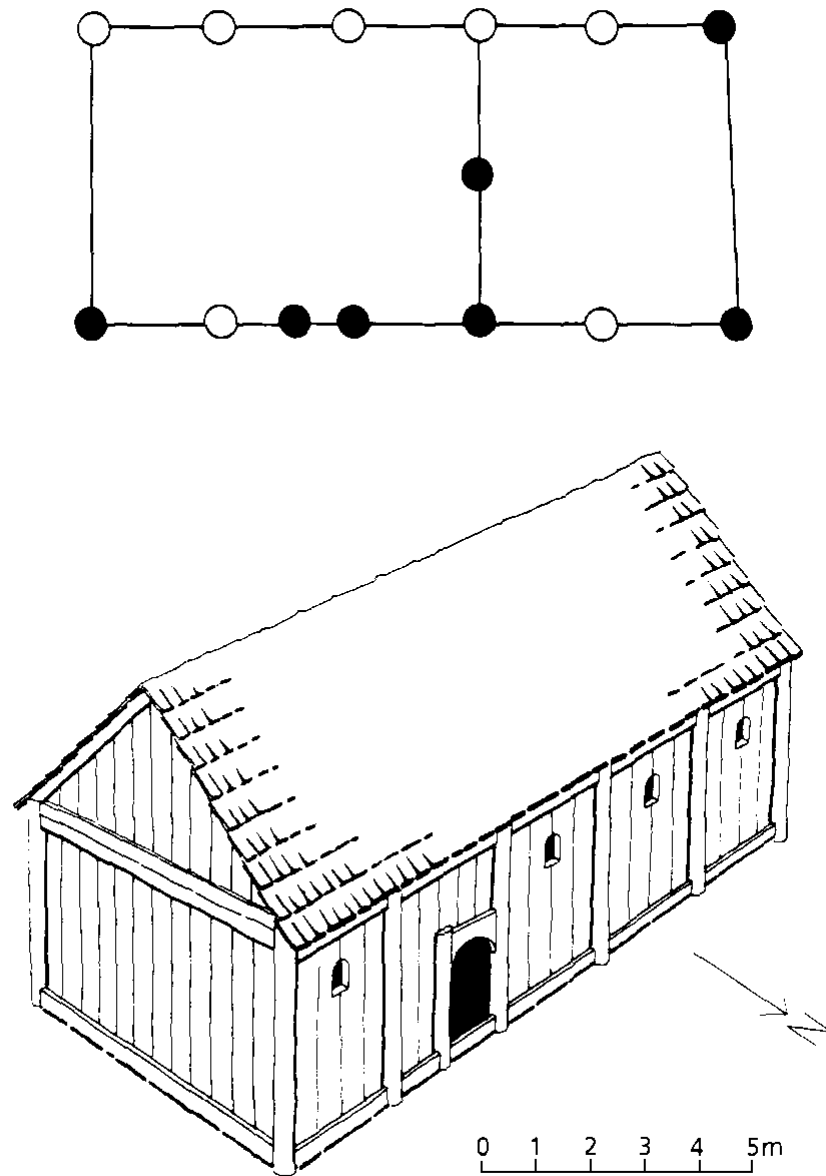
Martinskirche. Bau I, Grundriß und Rekonstruktion
